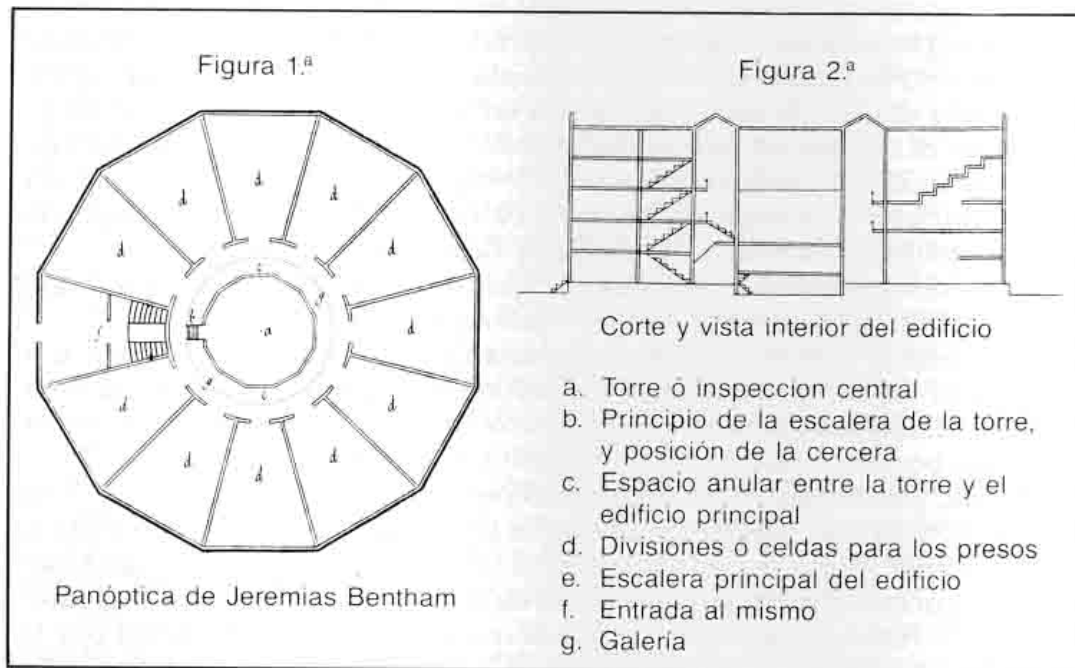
Planta y alzado del Panóptico de Jeremy Bentham.
